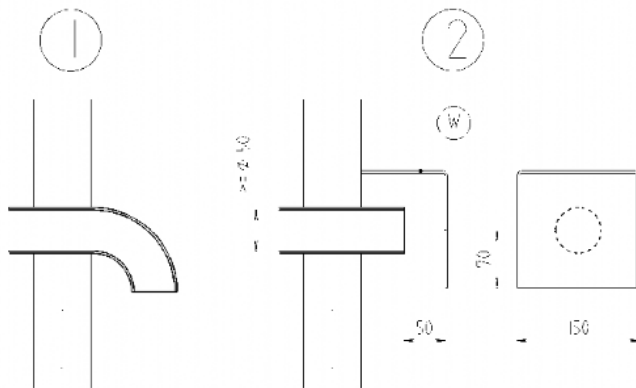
Protection du conduit d'amenée d'air contre le vent
